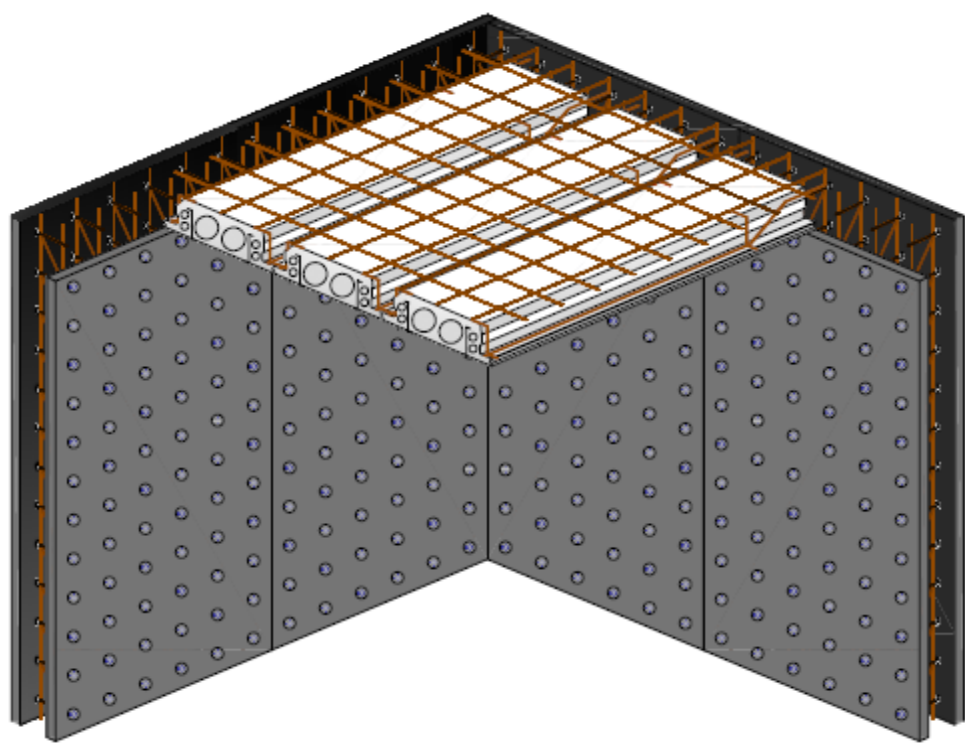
Vue 3D de liaison entre hourdis et PLASTBAU-3®
